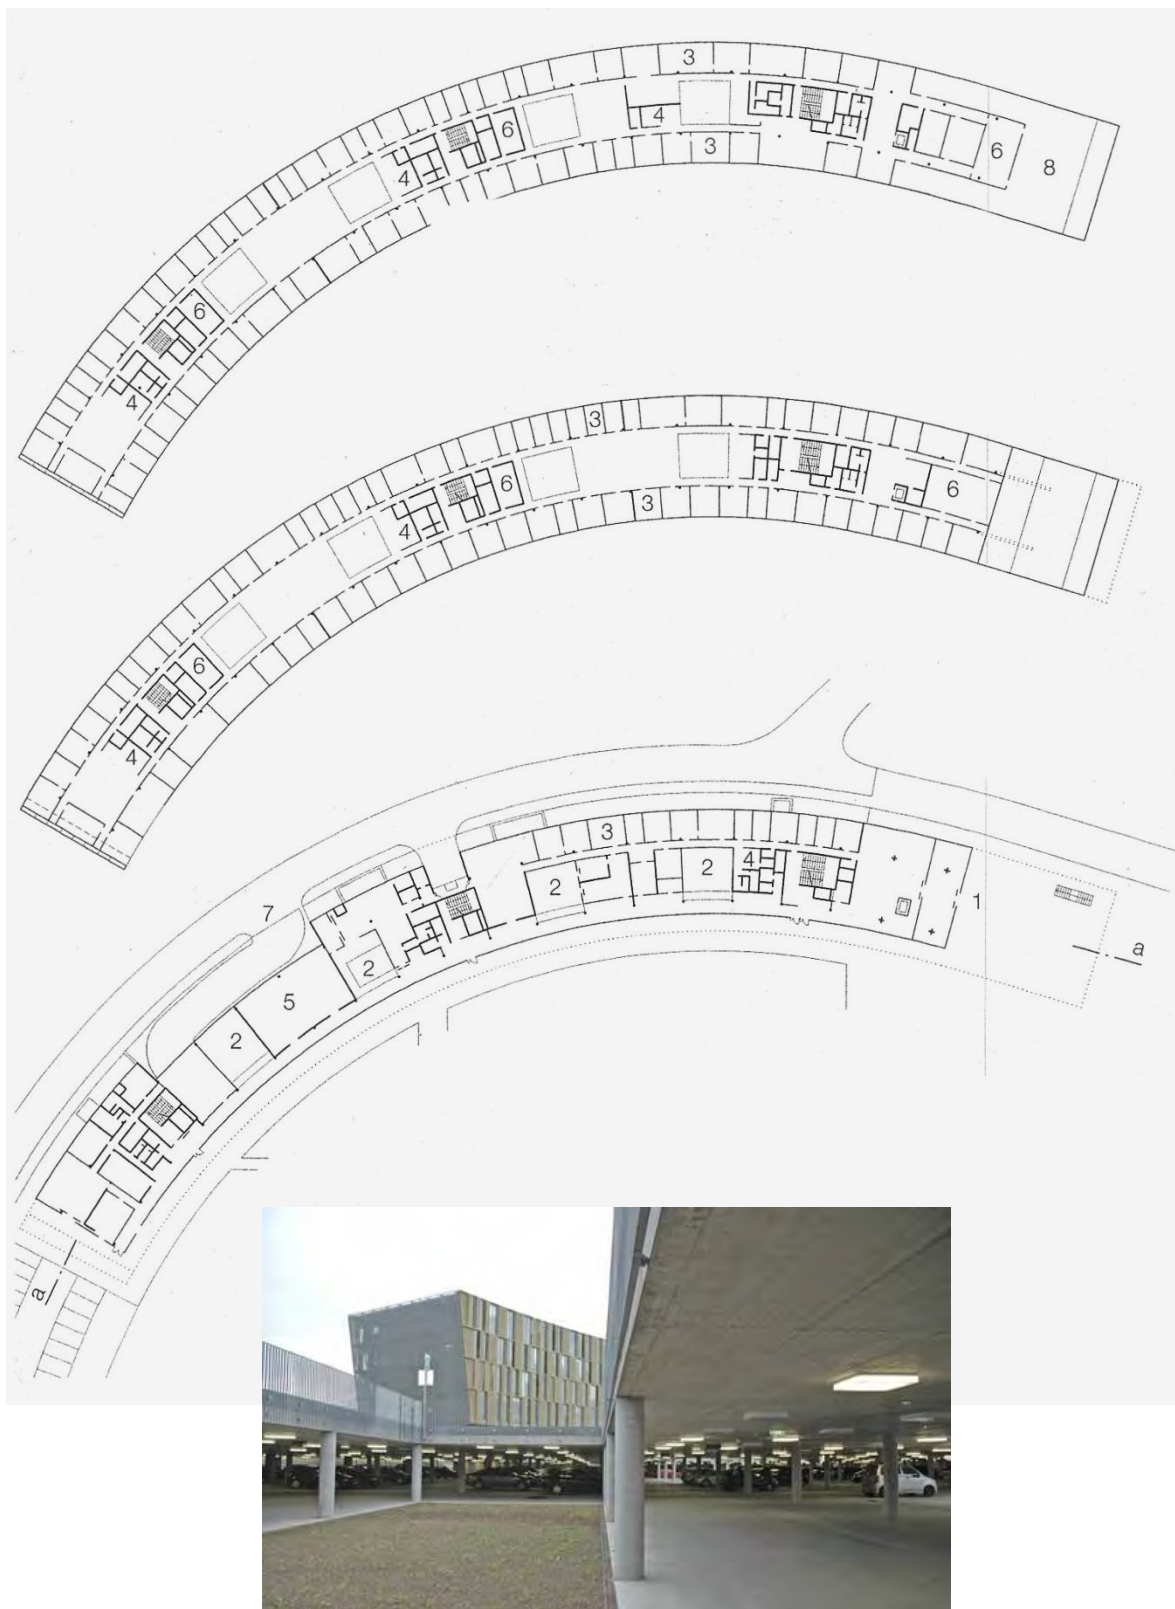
а – планы этажей: 1 – вход; 2 – атриум; 3 – офис; 4 – чайные комнаты; 5 – архив; 6 – конференц-залы; 7 – проезд к парковке; 8 – терраса на крыше;
